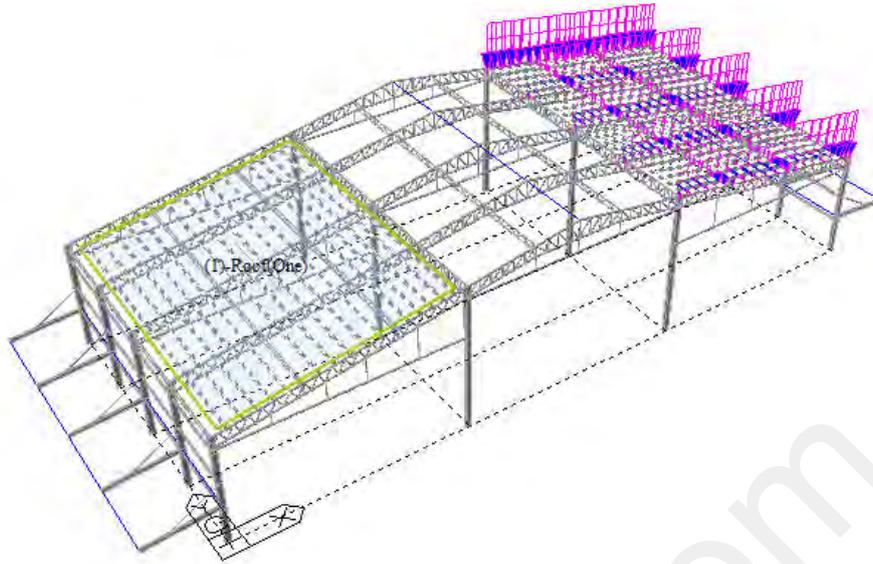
ขั้นตอนของคำสั่ง Assign Floor Loads ใน Tree Menu
